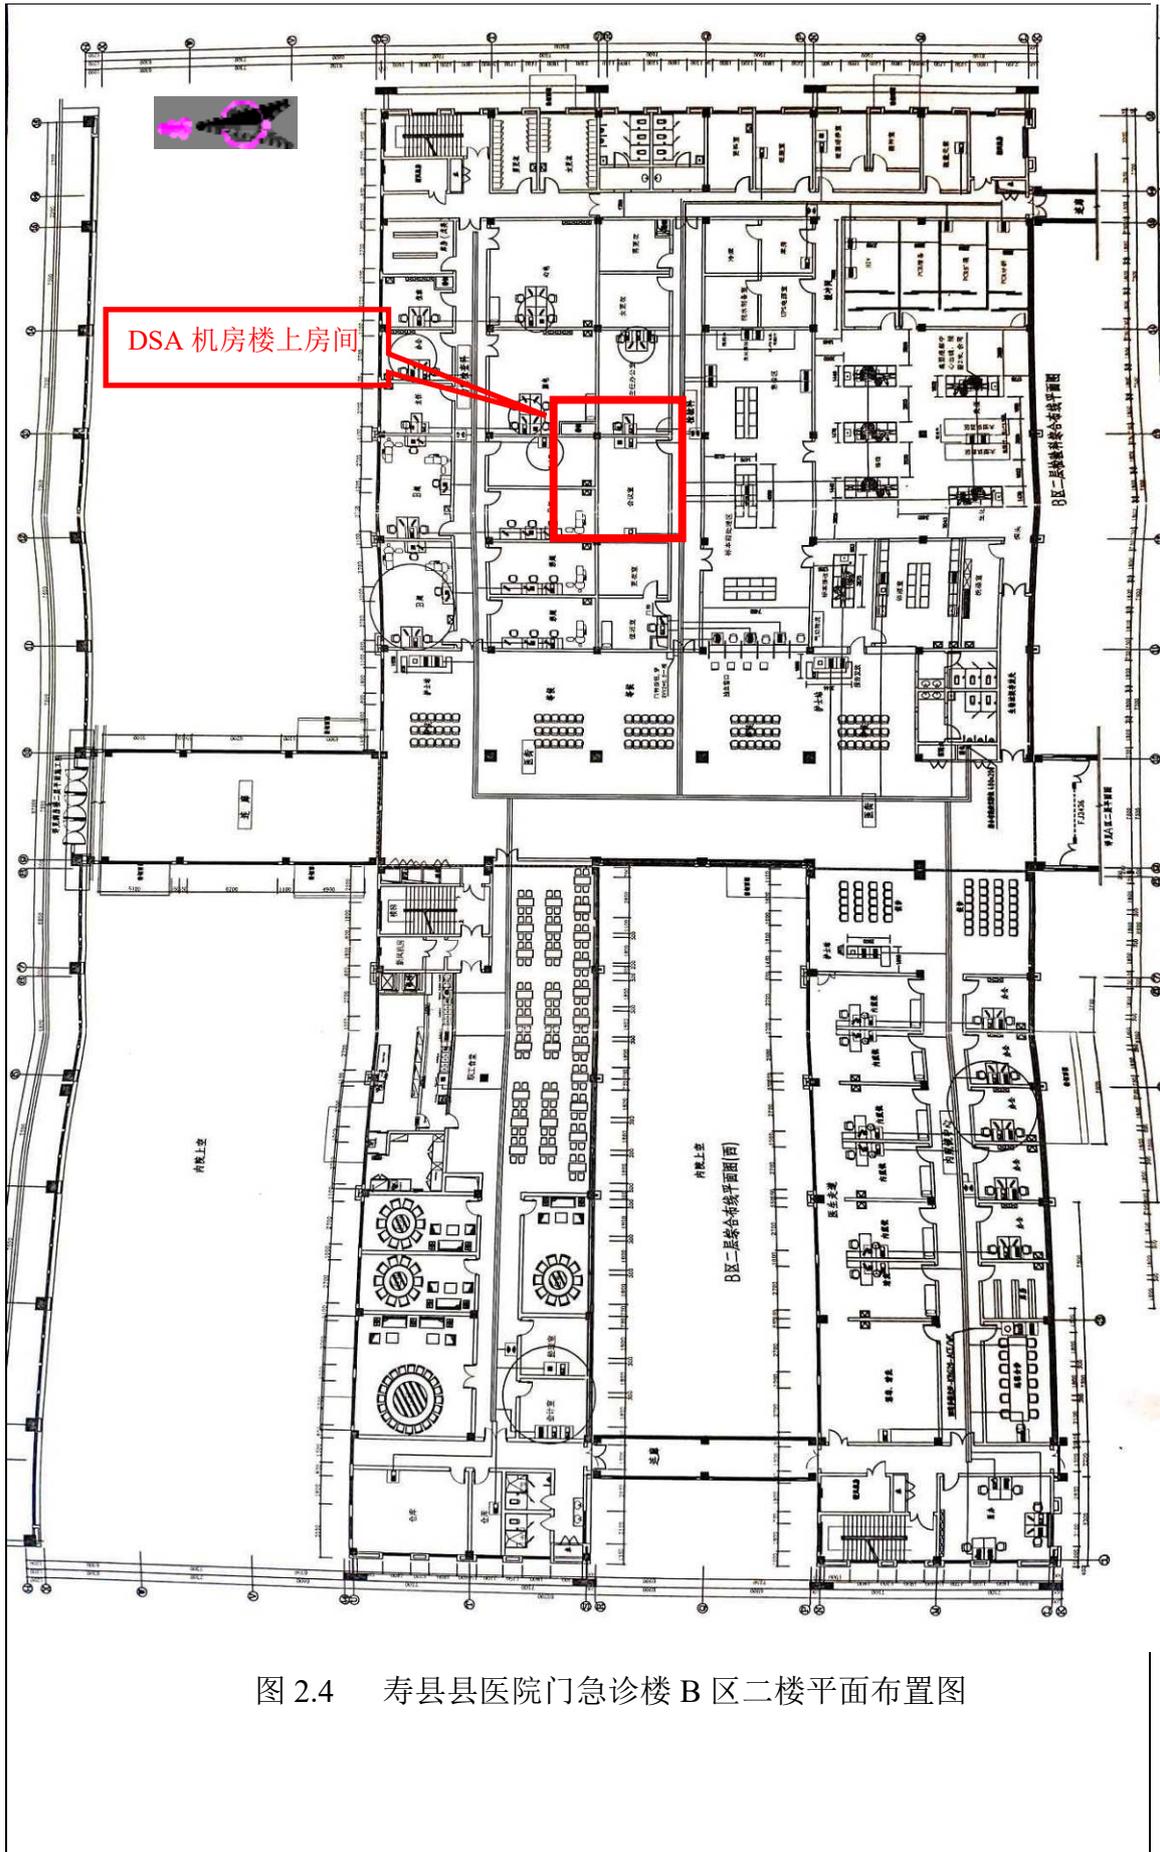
寿县县医院门急诊楼 B 区二楼平面布置图
